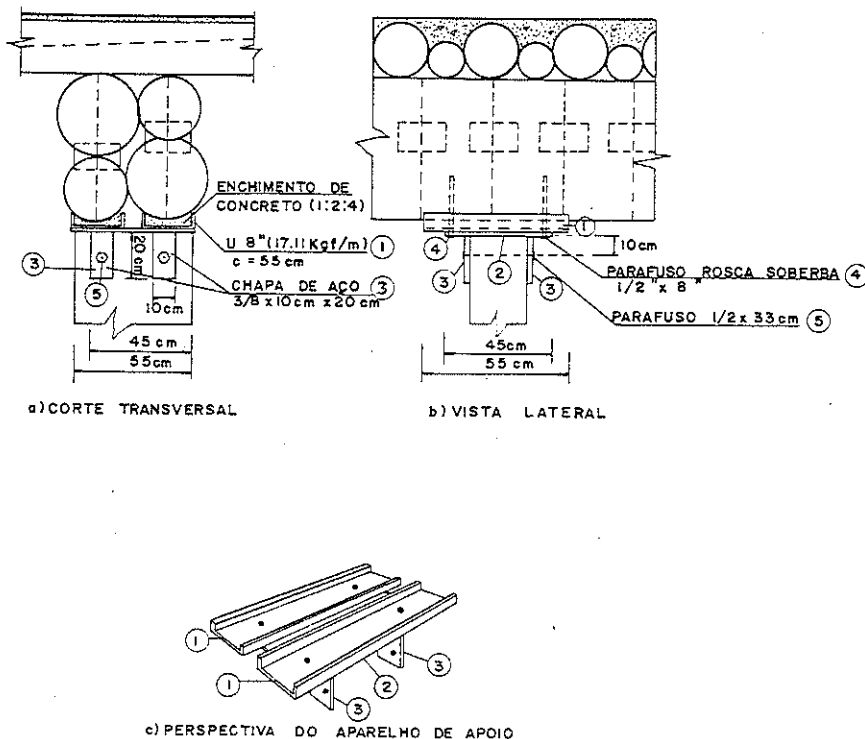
ESQUEMA DA LIGAÇÃO DE APOIO
